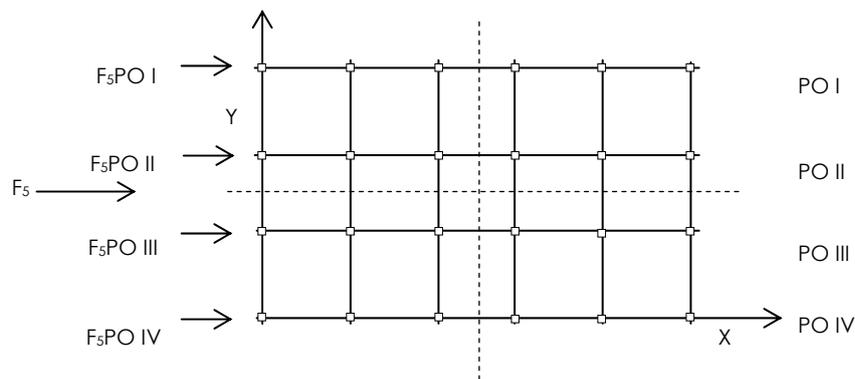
Fuerzas en los pódicos de la planta 5 en dirección x (autora: L. Basset)
